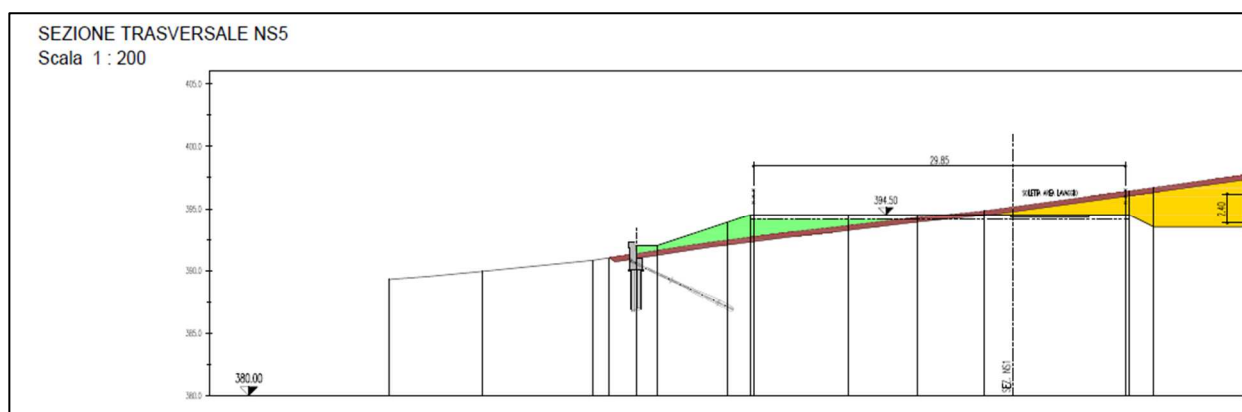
Sezione con vista dell'opera di stabilizzazione e sostegno (le opere di sostegno non sono in scala) da R35035_SezTr_01 Sezioni Trasversali.
